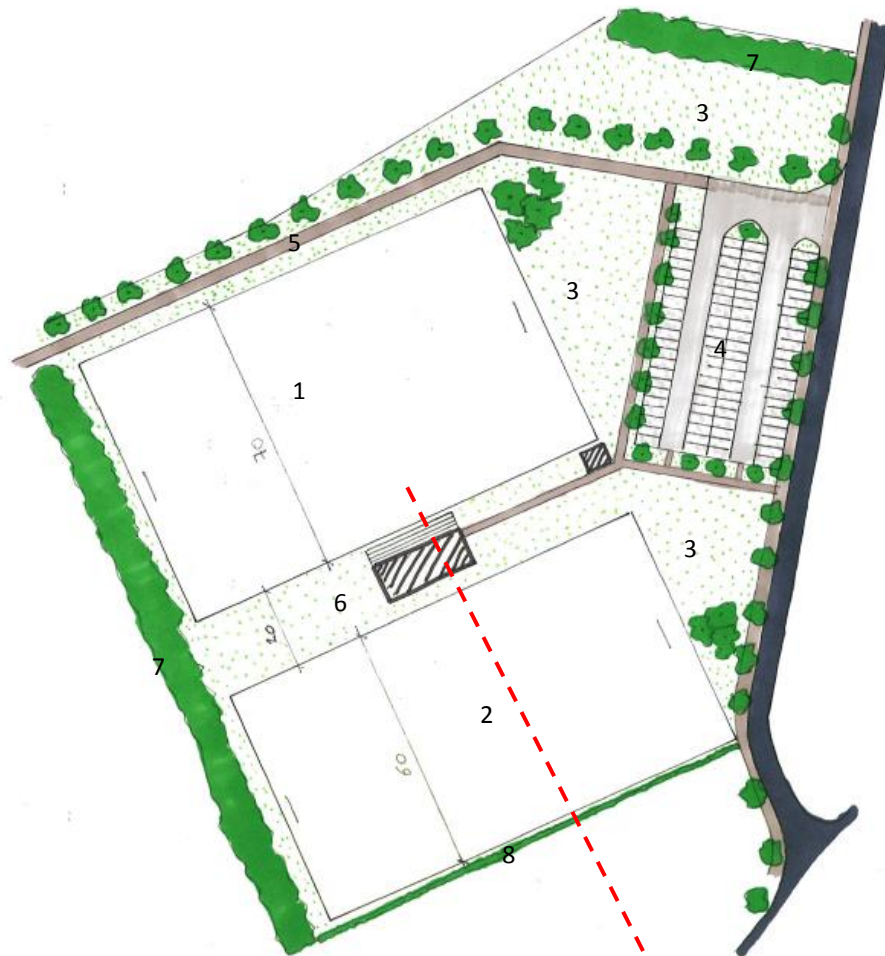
Gewenste ruimtelijke structuur Meldert, bron: GRS Lummen
